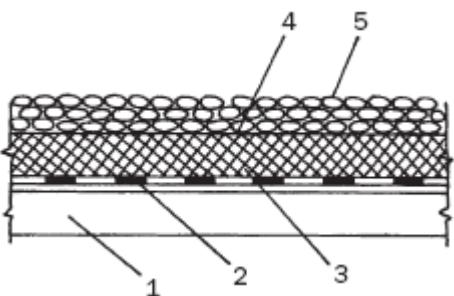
Инверсионная кровля: 1 – перекрытие; 2 – гидроизоляция; 3 – утеплитель из экструдированного пенополистирола; 4 – фильтрующий материал; 5 – слой гравия толщиной 50 мм
